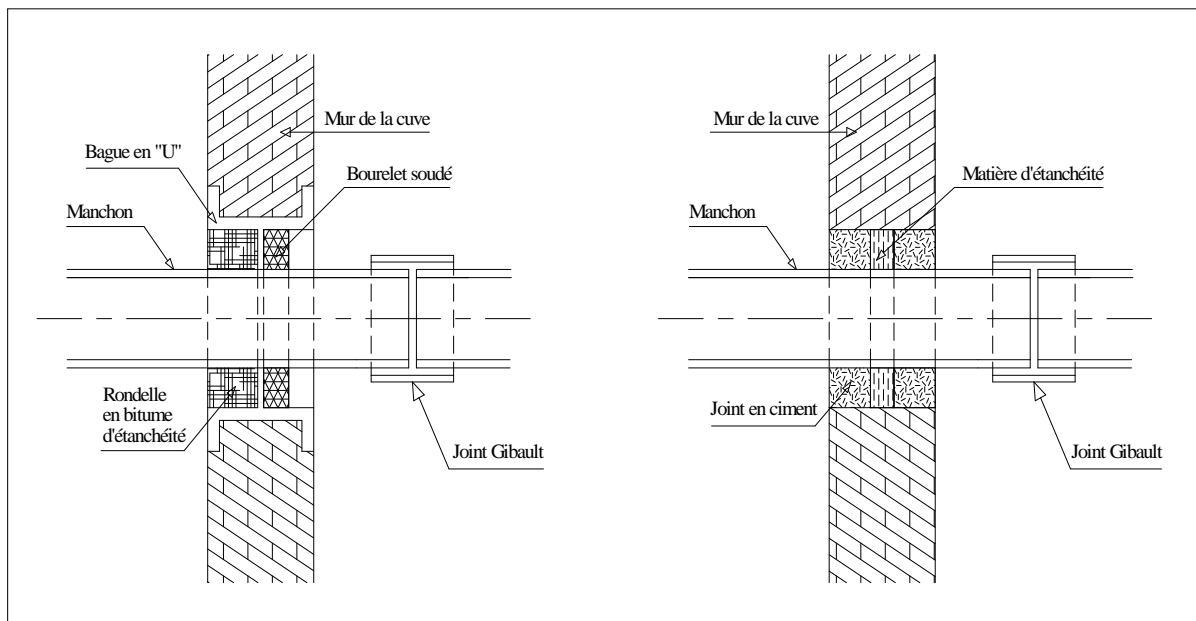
Traversée des conduites (manchon à bout lisse)
